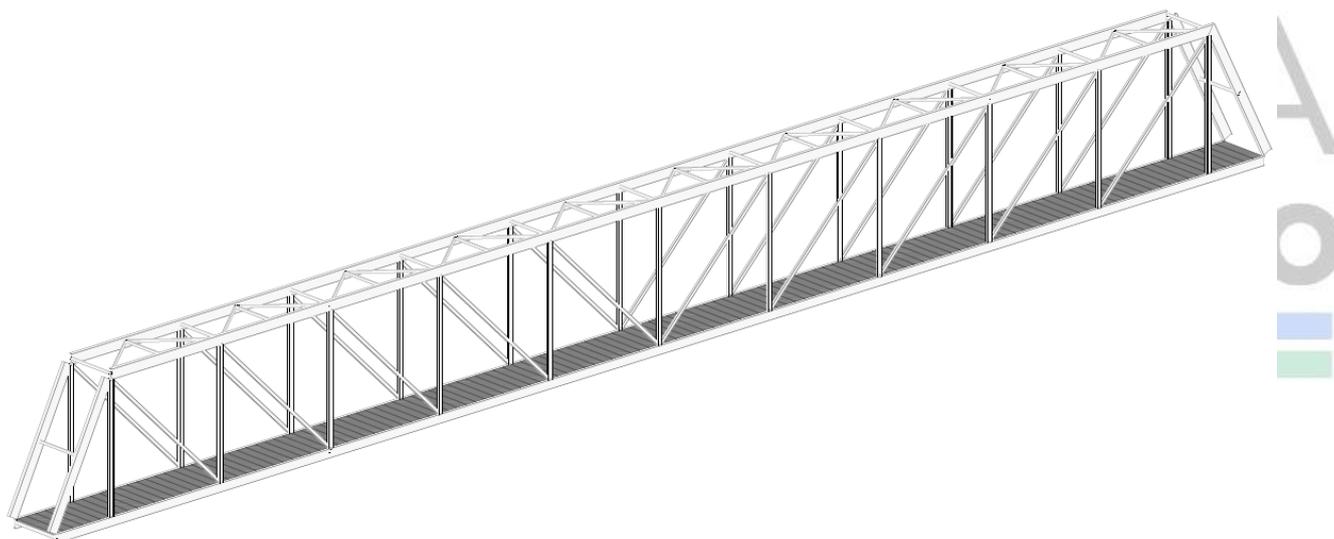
Vista em 3D da estrutura da passarela metálica.
